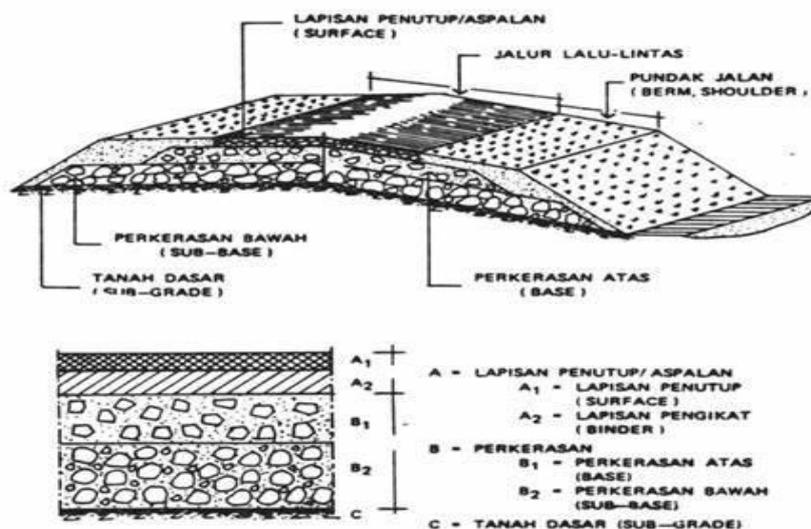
Desain Penampang Jalan & Drainase Bahu Jalan
